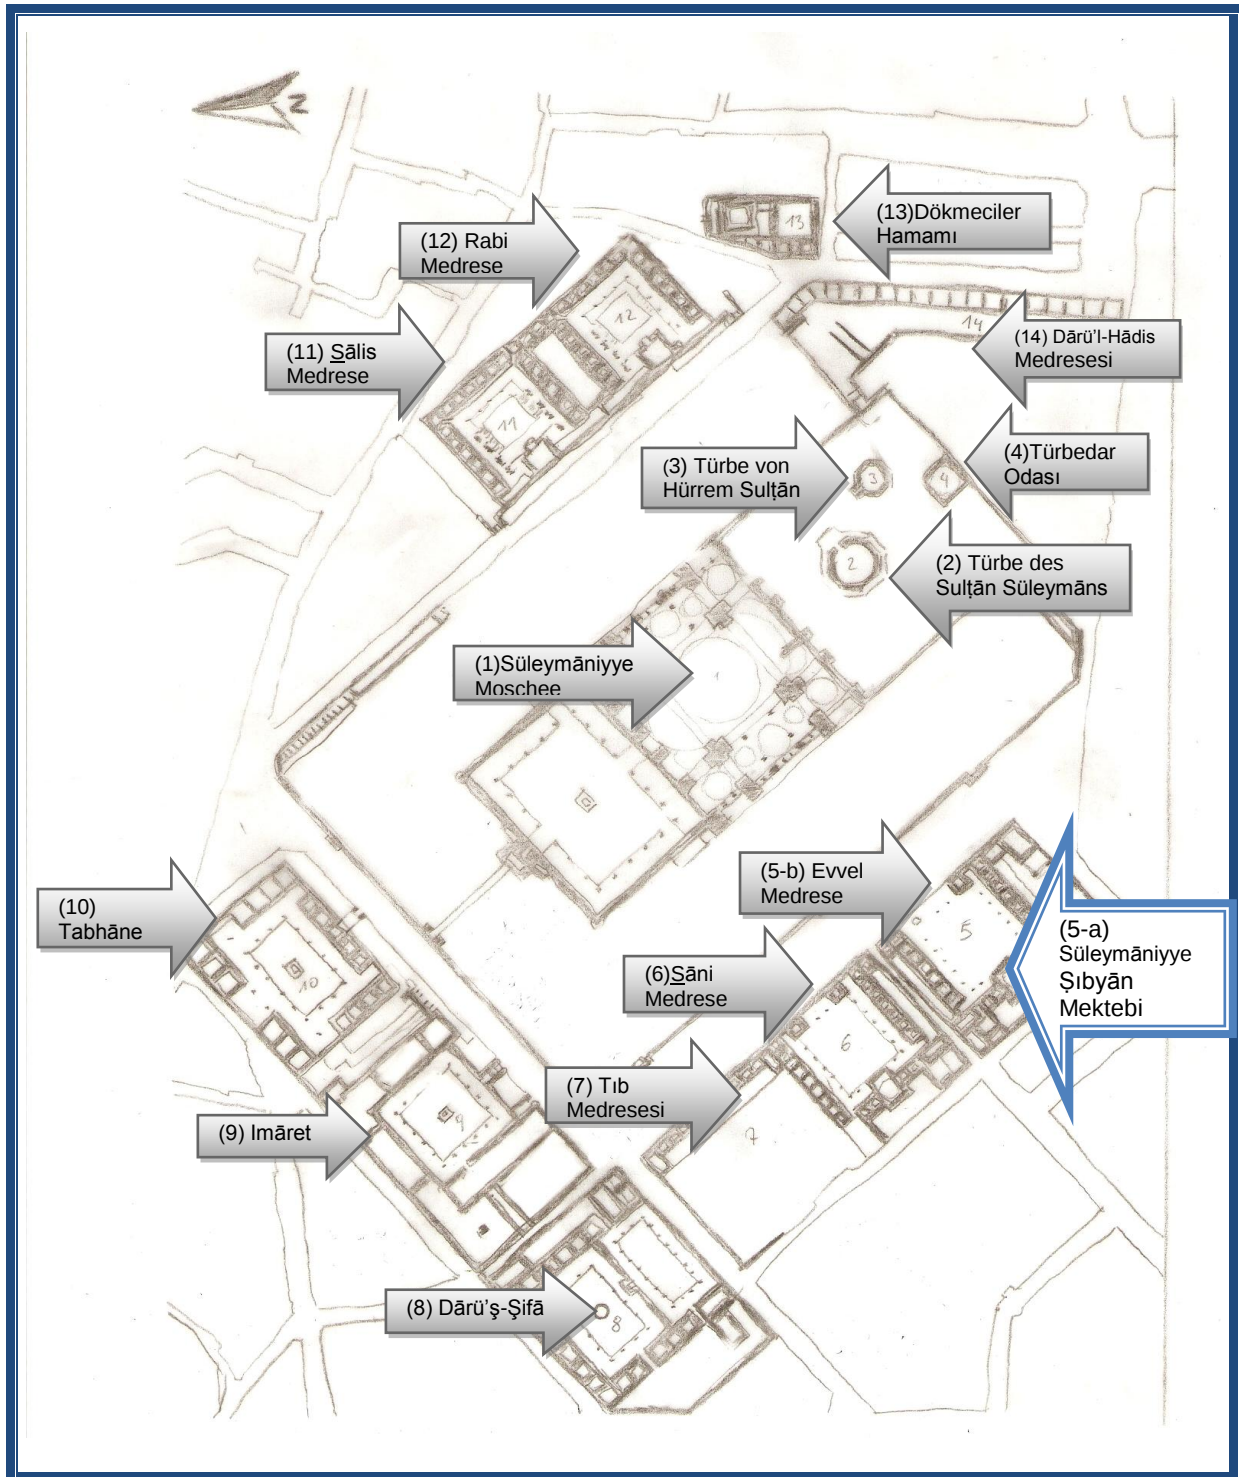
Der Lageplan des Stiftungskomplexes Süleymāniyye⁶⁶³
